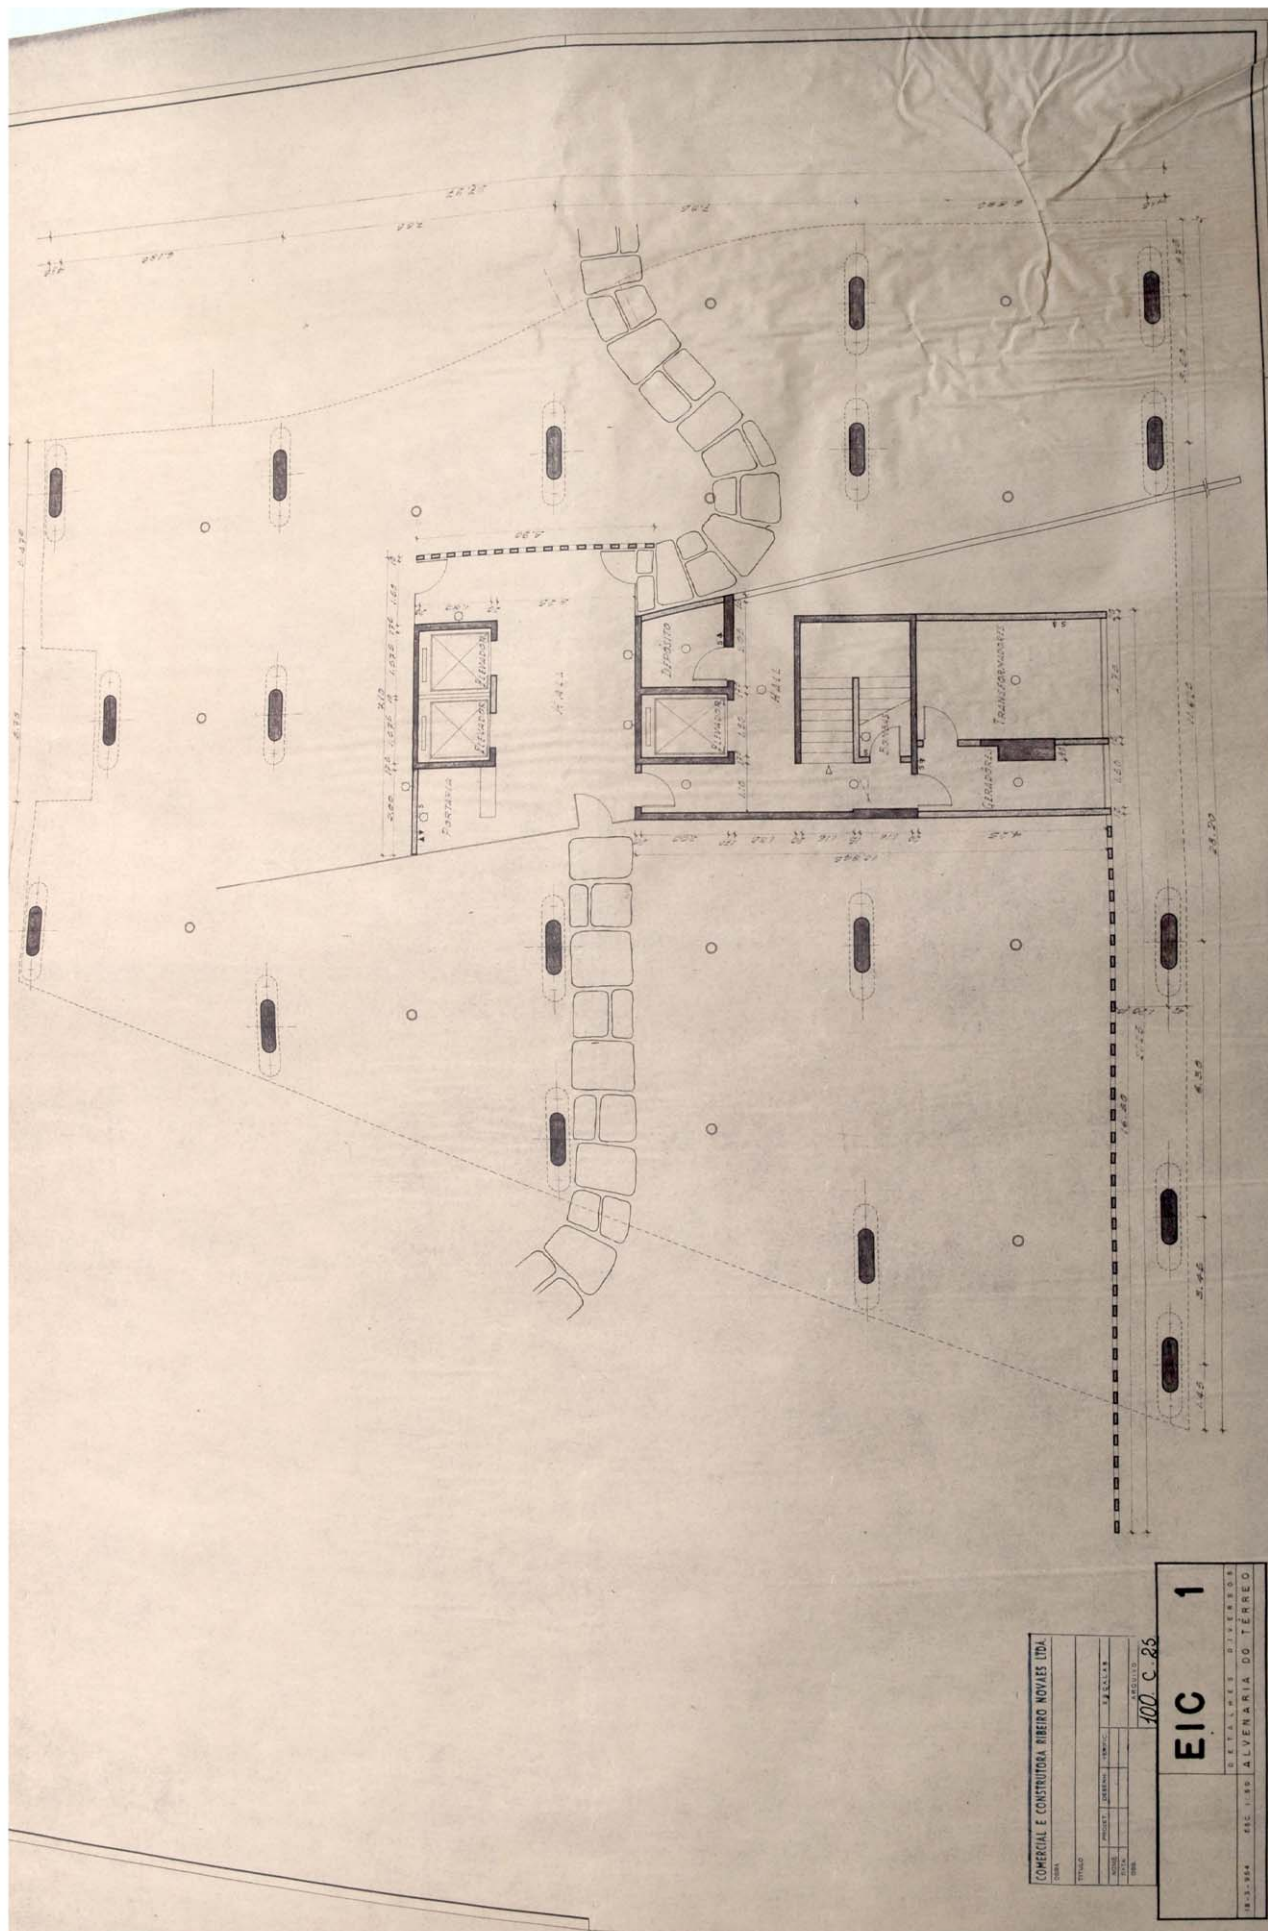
Planta Pavimento Tipo. Fonte: Arquivo Pessoal Eng° Noyr Rodrigues.
